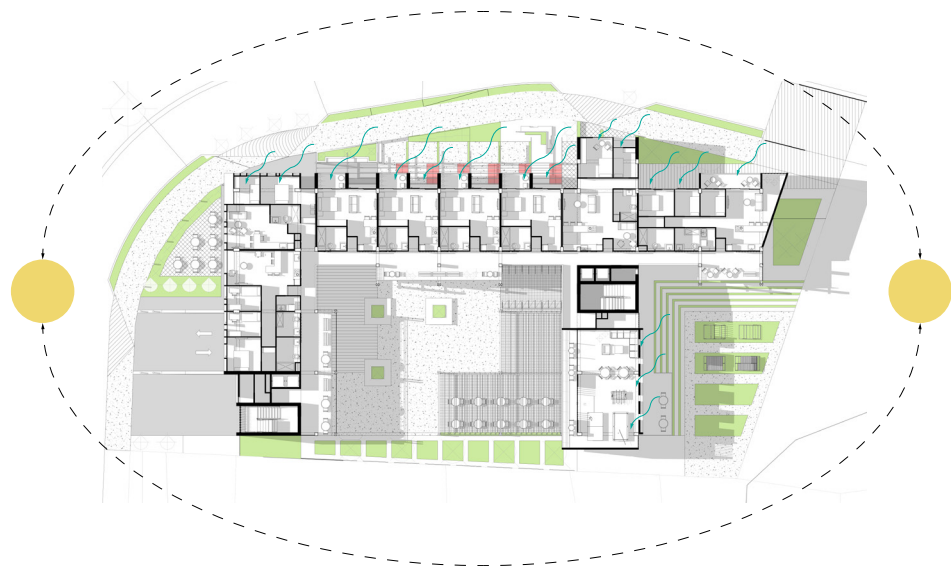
Corte planta estrategias bioclimáticas. Fuente: Elaboración propia.
